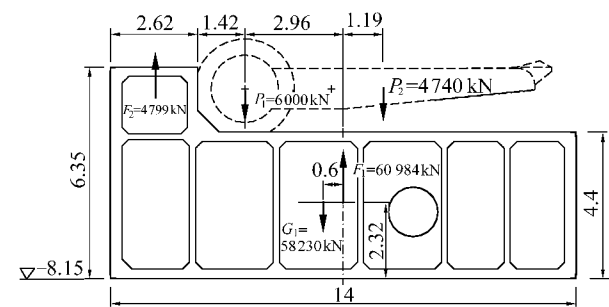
闸底板结构及形心、浮心位置示意图(单位: m)
